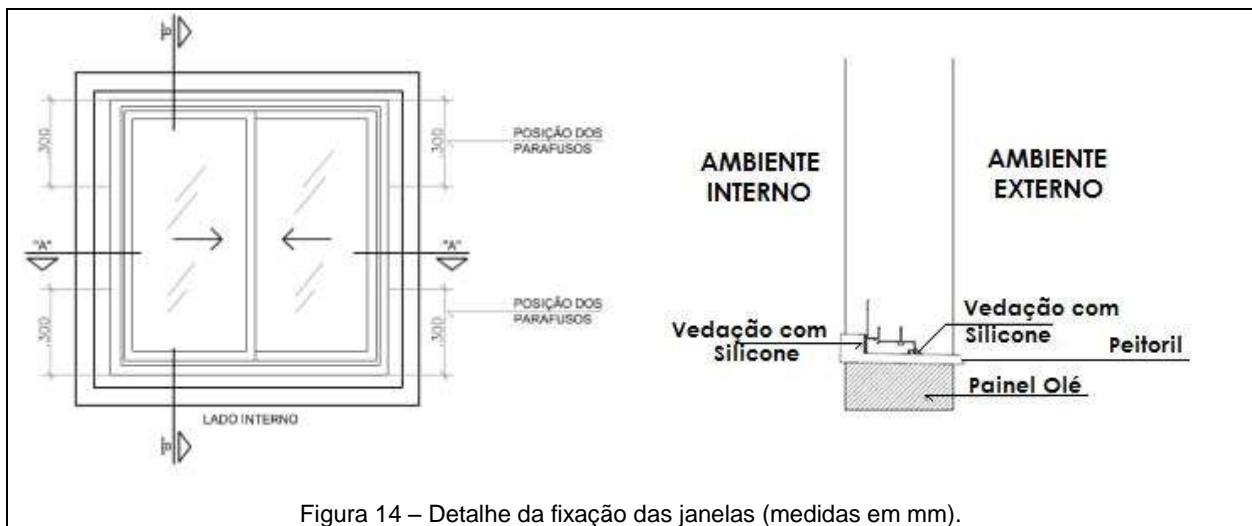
Detalhe da fixação das janelas (medidas em mm).
